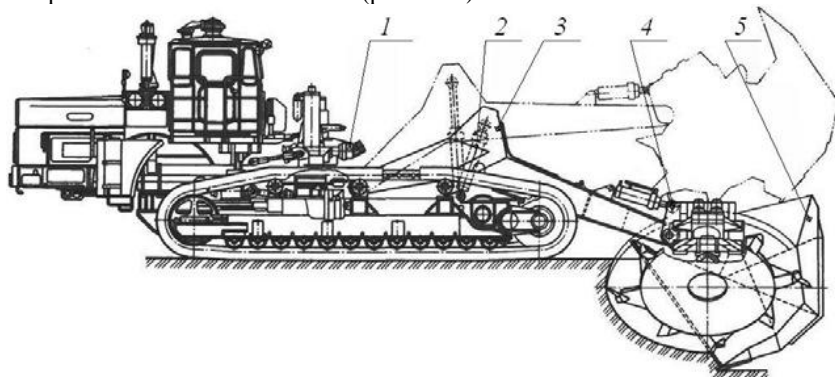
Двухфрезерный экскаватор-каналокопатель ЭТР-173: 1 – приводная насосная станция; 2 – гидроцилиндры подъема; 3 – стрела; 4 – роторы; 5 – нож зачистной
